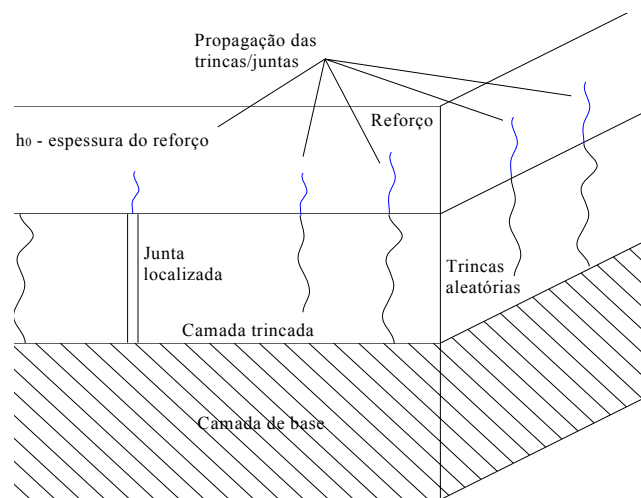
Pavimento trincado rehabilitado com uma mistura betuminosa (adaptado de Vanelstraete & de Bondt, 1997)
